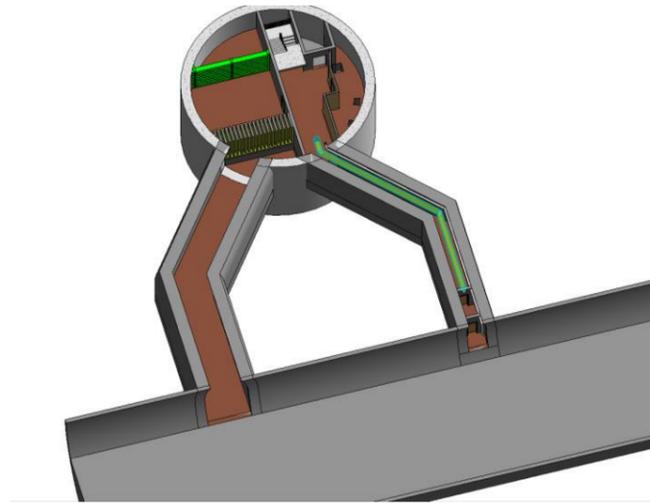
Coupe niveau tunnel Rameaux d'accès secours et rameau de ventilation / Décompression
